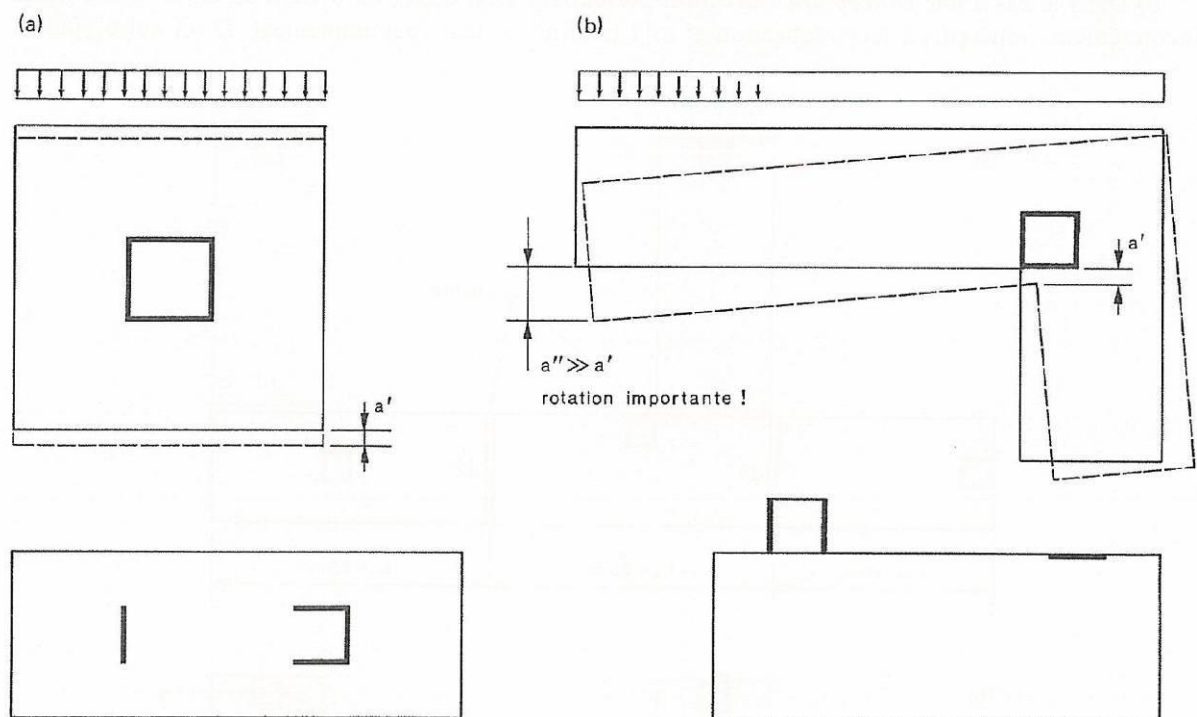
Structure poteaux-poutres avec voiles de contreventement
